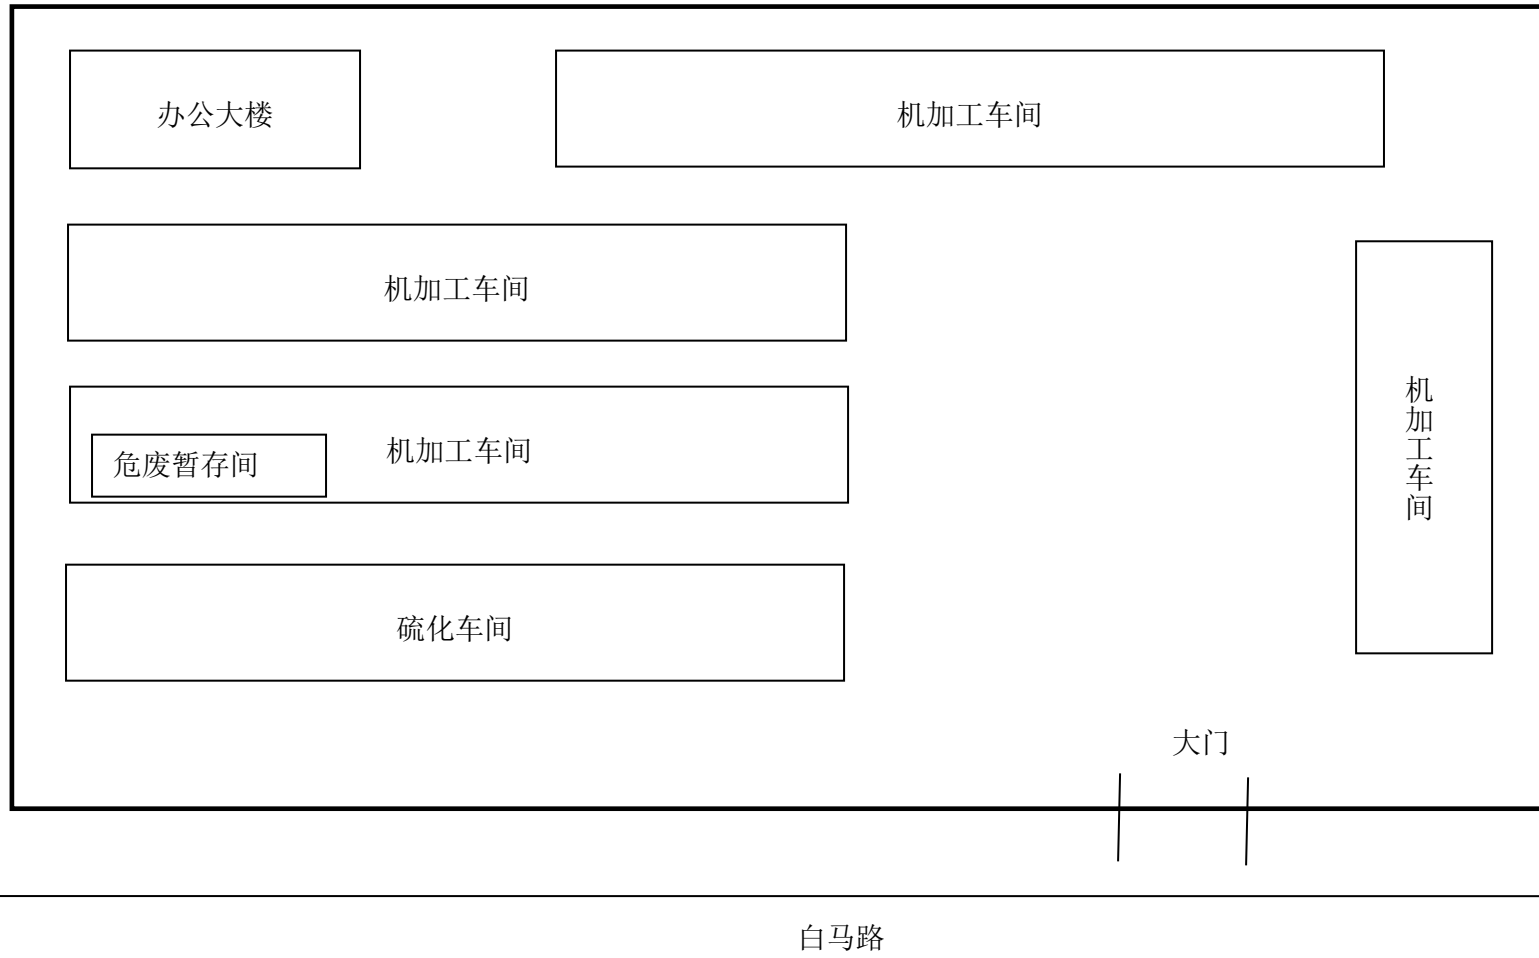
柳州华威合力工程技术有限公司总平面布置图
